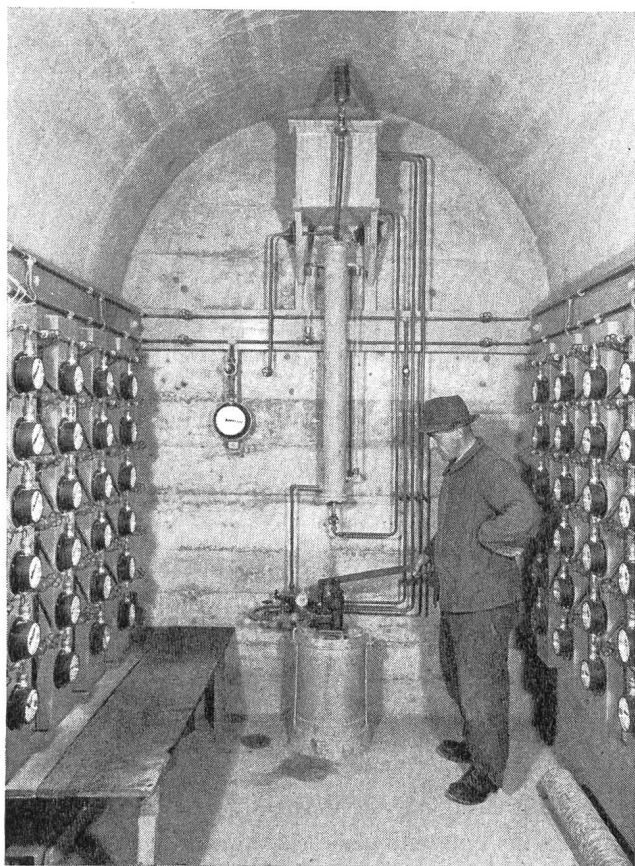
Erddamm Marmorera. Apparatekammer mit Manometern und Installation zur Messung der Porenwasserspannungen. (Photo E. Brügger)
